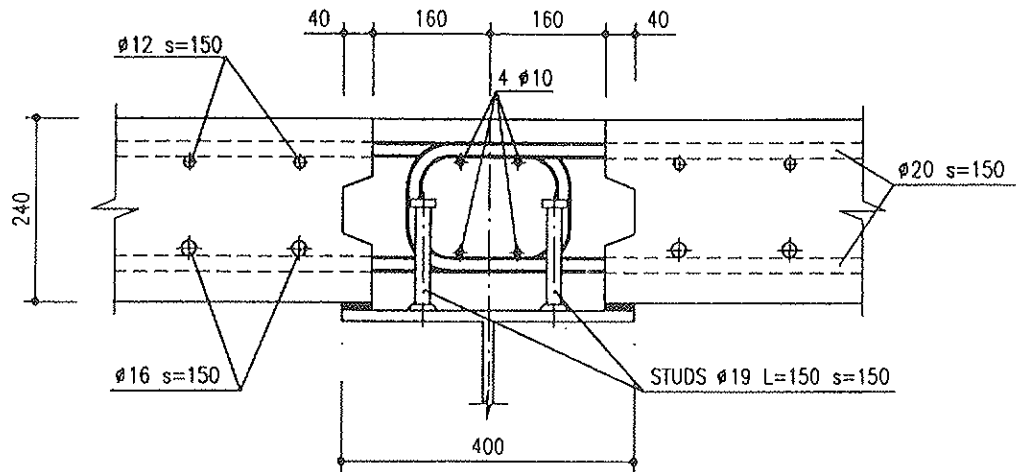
Puente Atirantado. Detalle de conexión entre placas prefabricadas.
